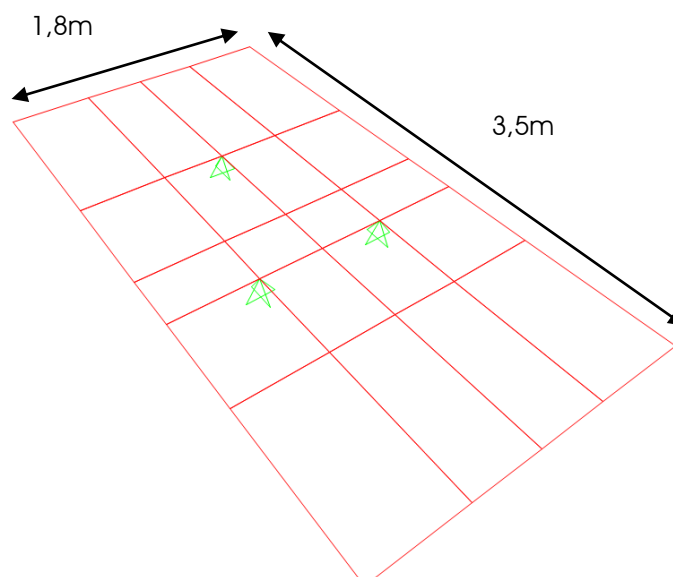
Mallado de la losa con detalle de nodos y punto de apoyo.
